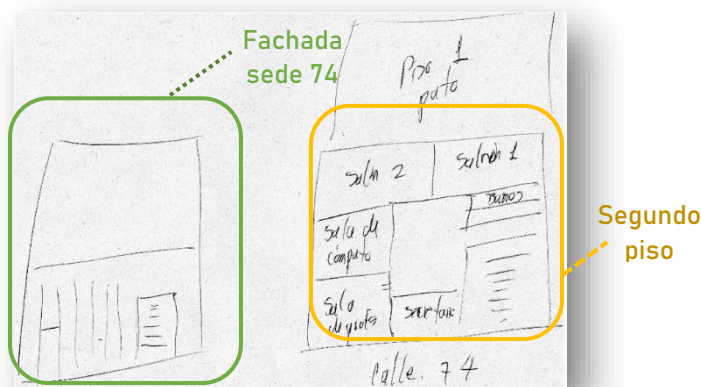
plano fachada y segundo piso instalación de la 74, egresado DR
